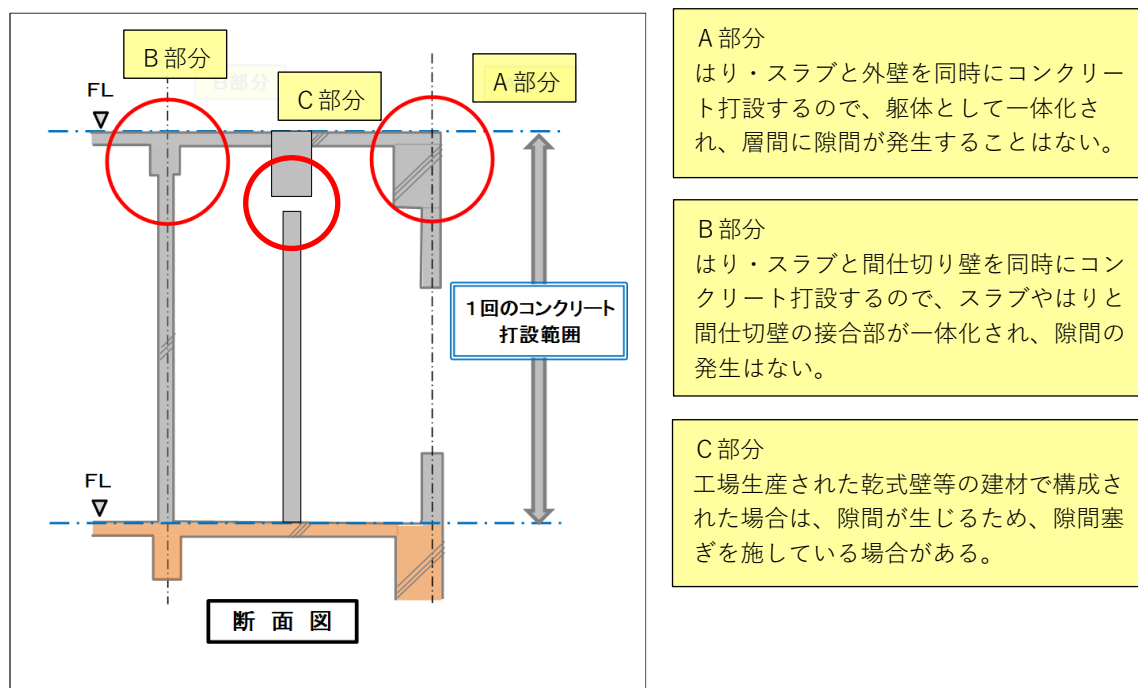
鉄筋コンクリート造の外壁や間仕切り断面図
